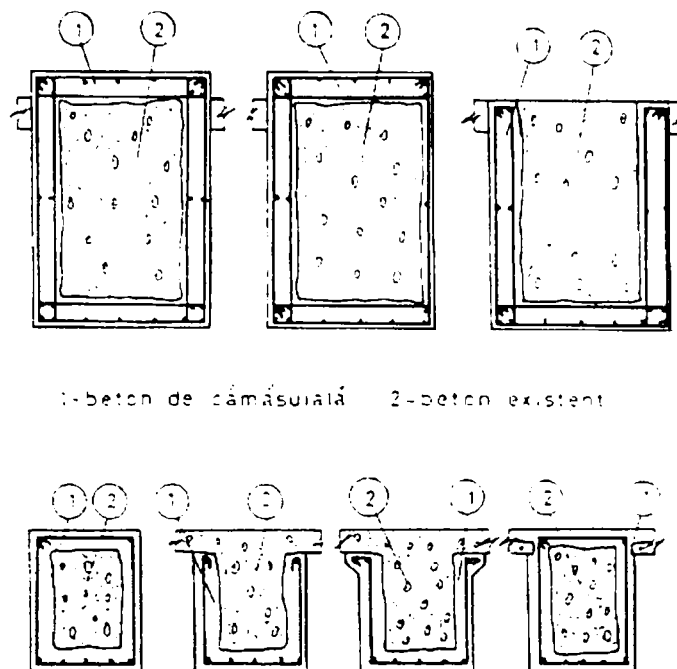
Consolidarea grinzilor din beton armat prin camasuire .
